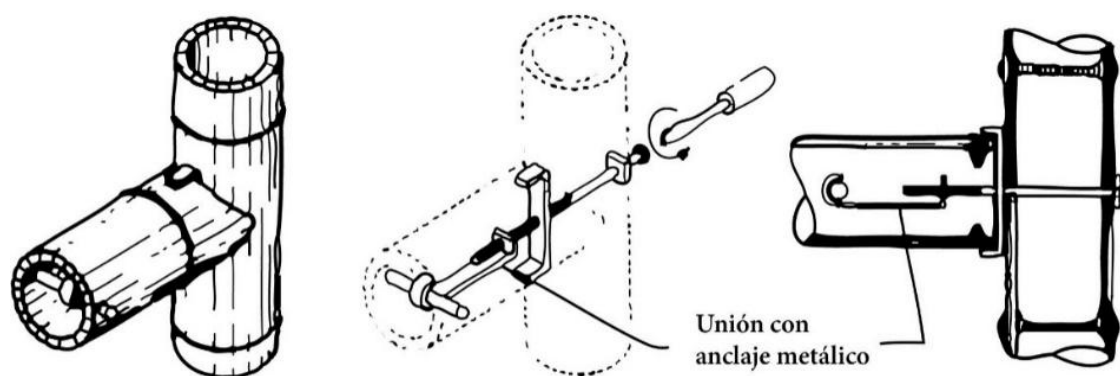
Detalhes de Ligações, união com encaixe metálico
